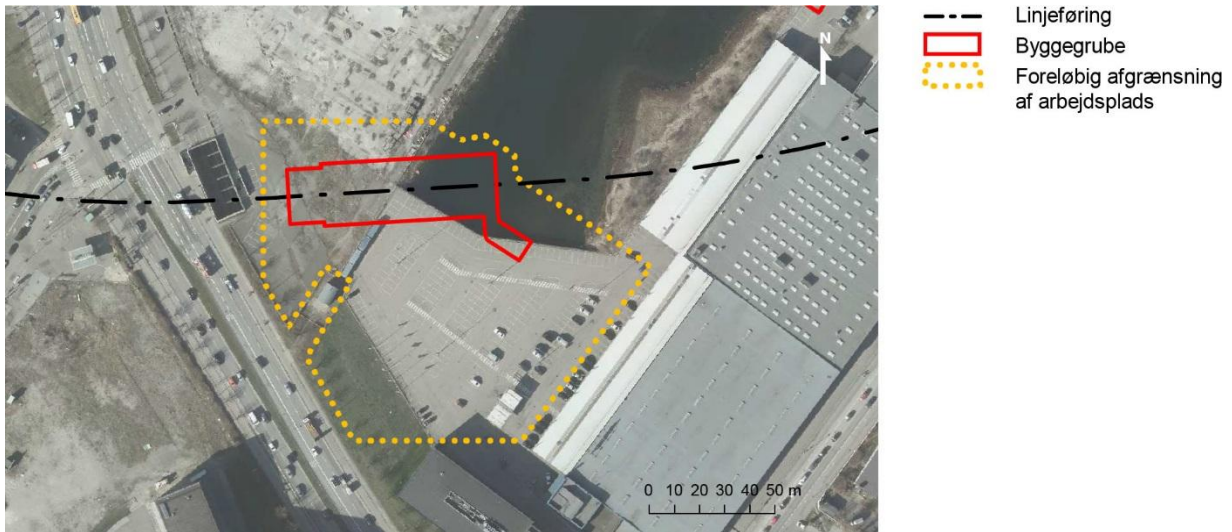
Oversigt over stationens placering og det forventede arbejdspladsareal v/ Sluseholmen Nord. Stationen placeres til dels på et opfyldt areal
